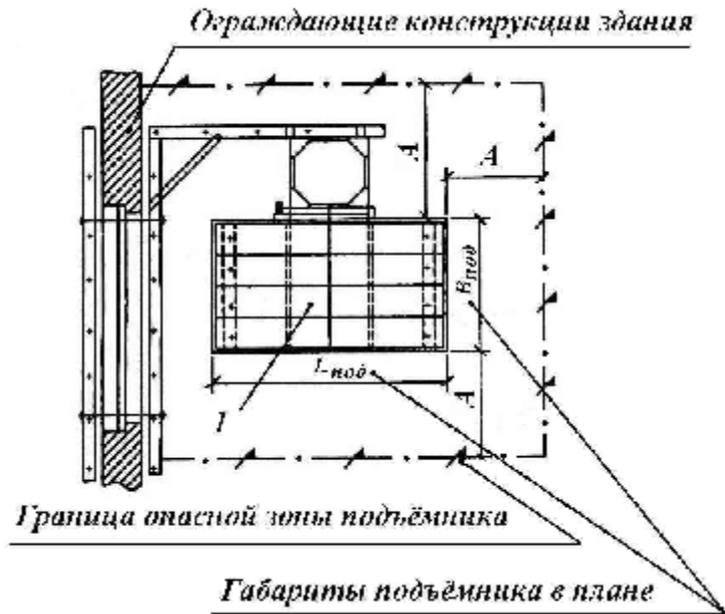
Схема определения опасной зоны при работе грузового подъемника:
